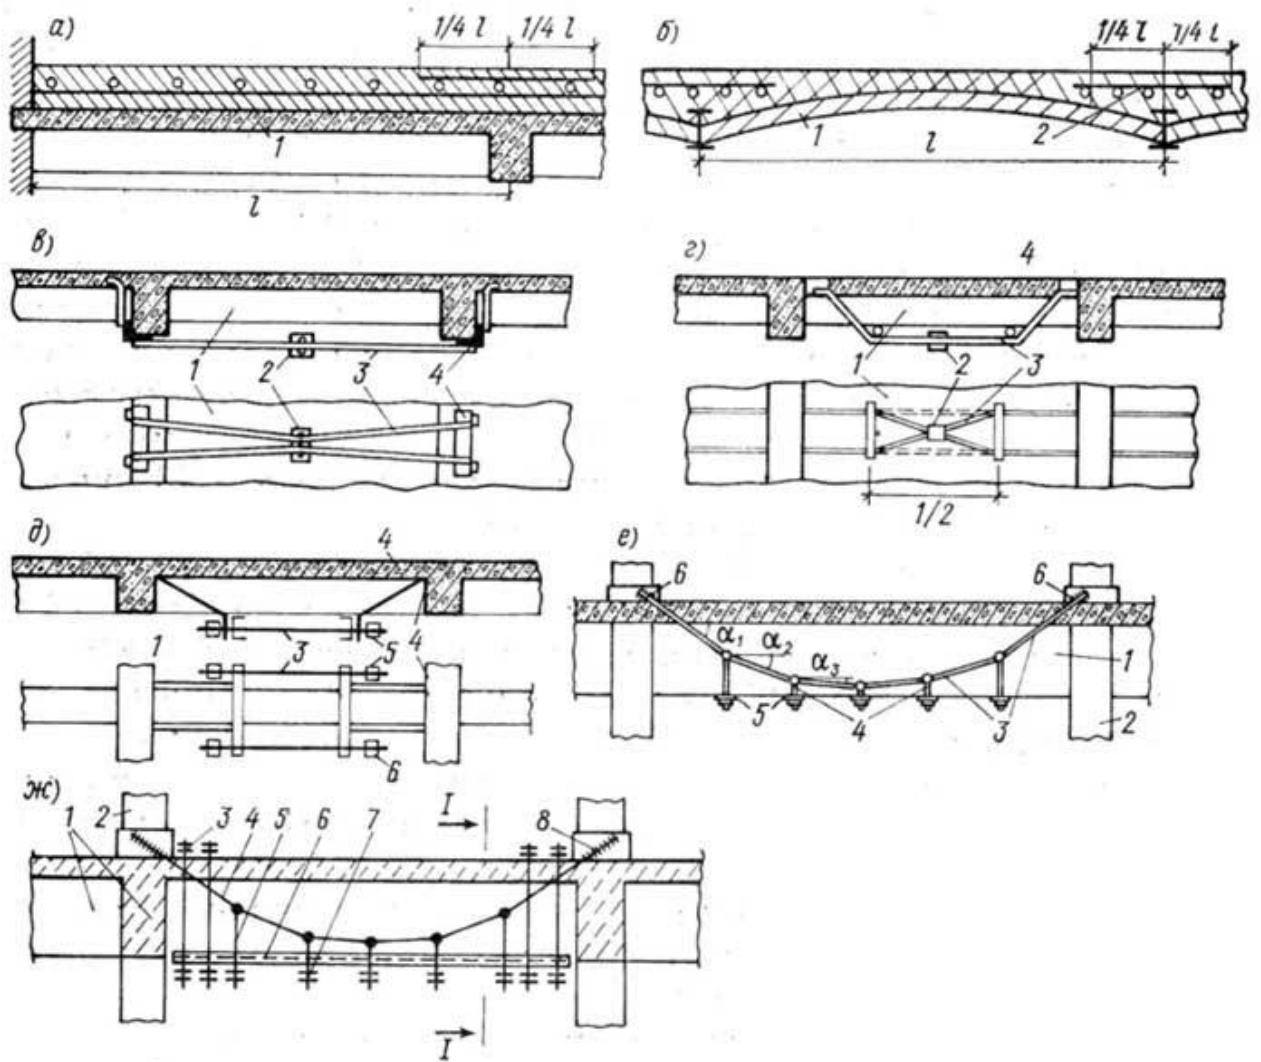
Способы усиления железобетонных перекрытий: а, б — наращиванием арматуры и бетона сверху перекрытия: 1 — существующее перекрытие; 2 — дополнительная арматура и бетон в, г, д — установкой шпренгелей снизу перекрытия: 1 — существующее перекрытие; 2 — стяжная муфта; 3 — тяжи; 4 — опорный узел; 5 — натяжные гайки е — шарнирно-стержневая предварительно-напряженная система; 1 — балка; 2 — колонна; 3 — тяжи; 4 — подвески; 5 — подкладки гайками на подвесках; 6 — крепление на опорах, ж — предварительно-напряженная шарнирно-стержневая система с швеллером-подкладкой и напряженными хомутами на концах балки: 1 — балка; 2 — колонна; 3 — напряженный хомут; 4 —тяж; 5 — напряженная подвеска; 6 — швеллер-подкладка; 7 — поперечная планка и гайки на подвесках; 8 — крепление тяжа на колонне
